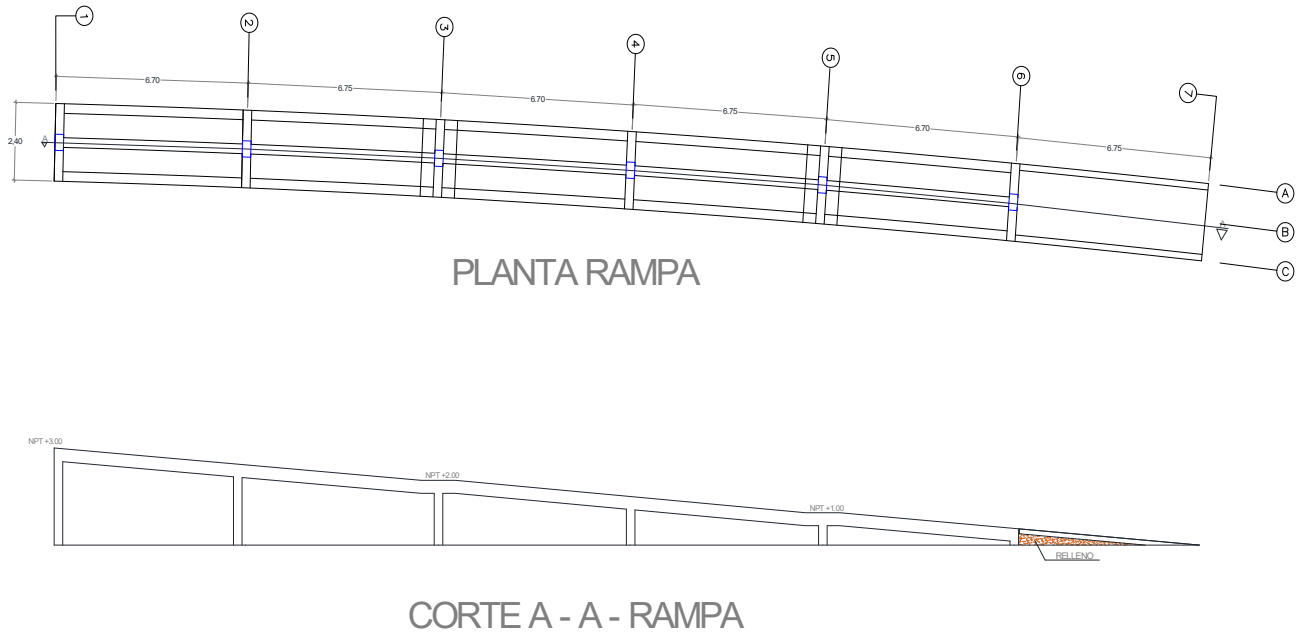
Estructuración de Rampa, planta y corte.
